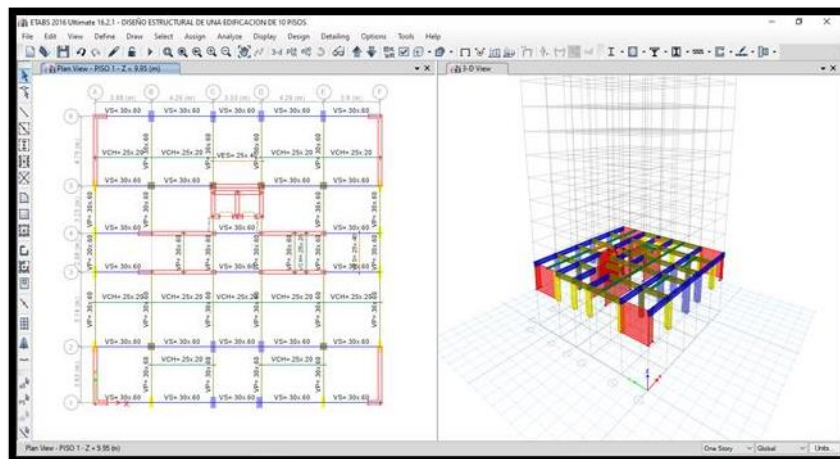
Vista de distribución de vigas y columnas en 2D y 3D en Etabs.
